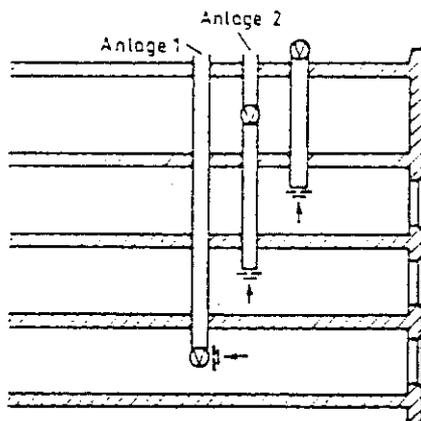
Entlüftungsanlagen mit getrennten Hauptleitungen und Abluftabführung über Dach
